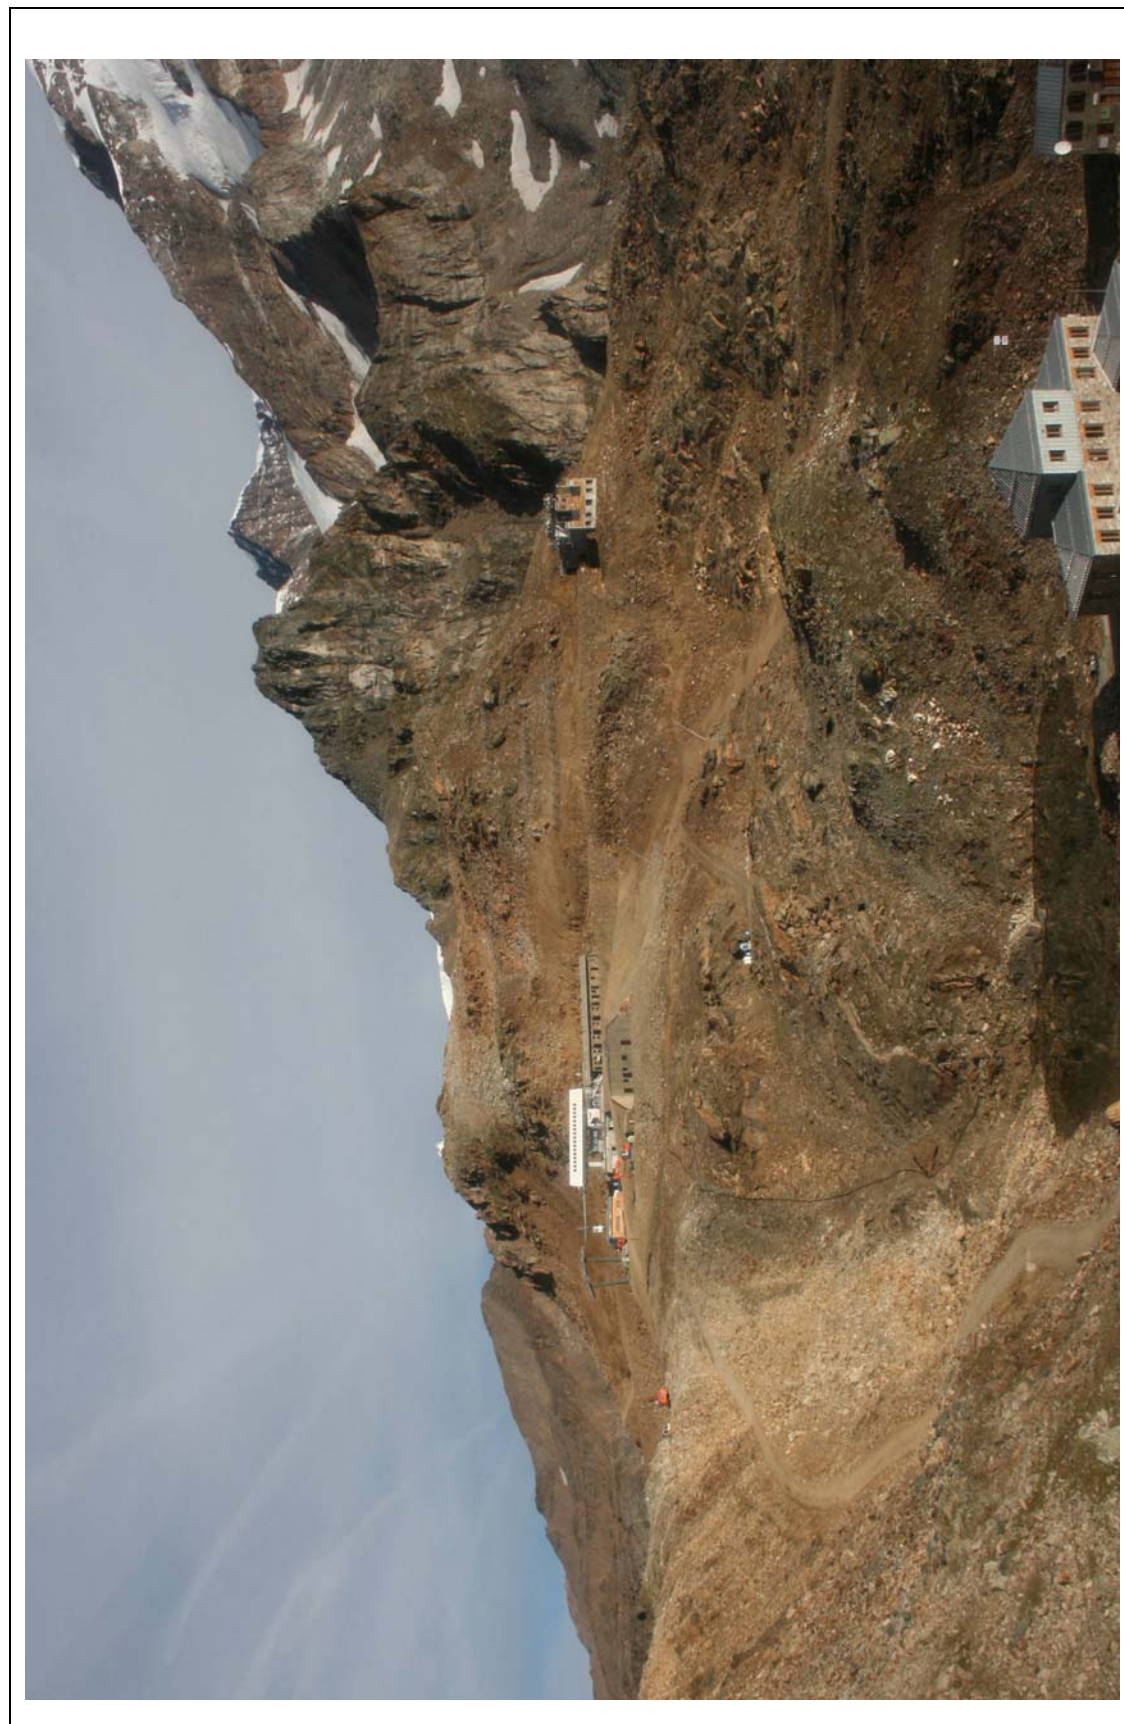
/7 Fotoinserimento della stazione di monte. Vista panoramica frontale - Stato attuale
